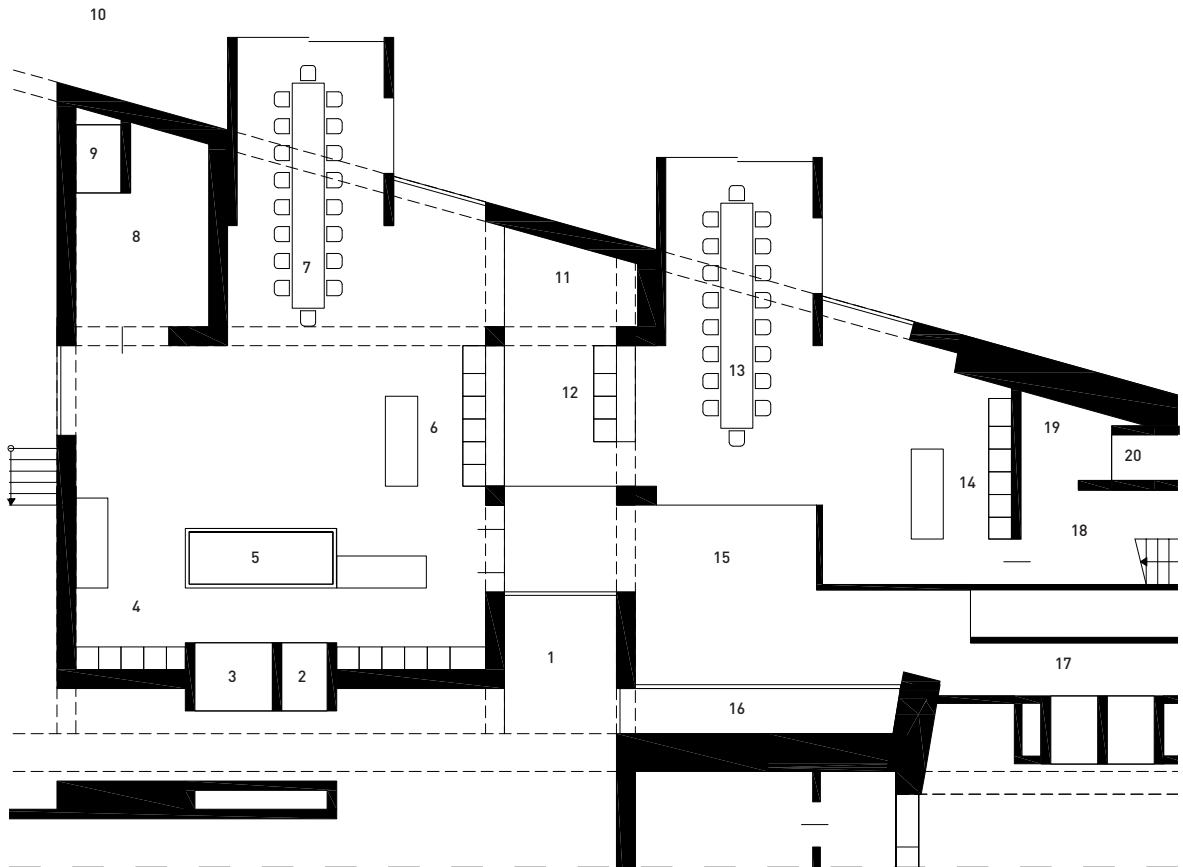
Grundriss Forschungsbereich Testküche +0,00m M1:200
